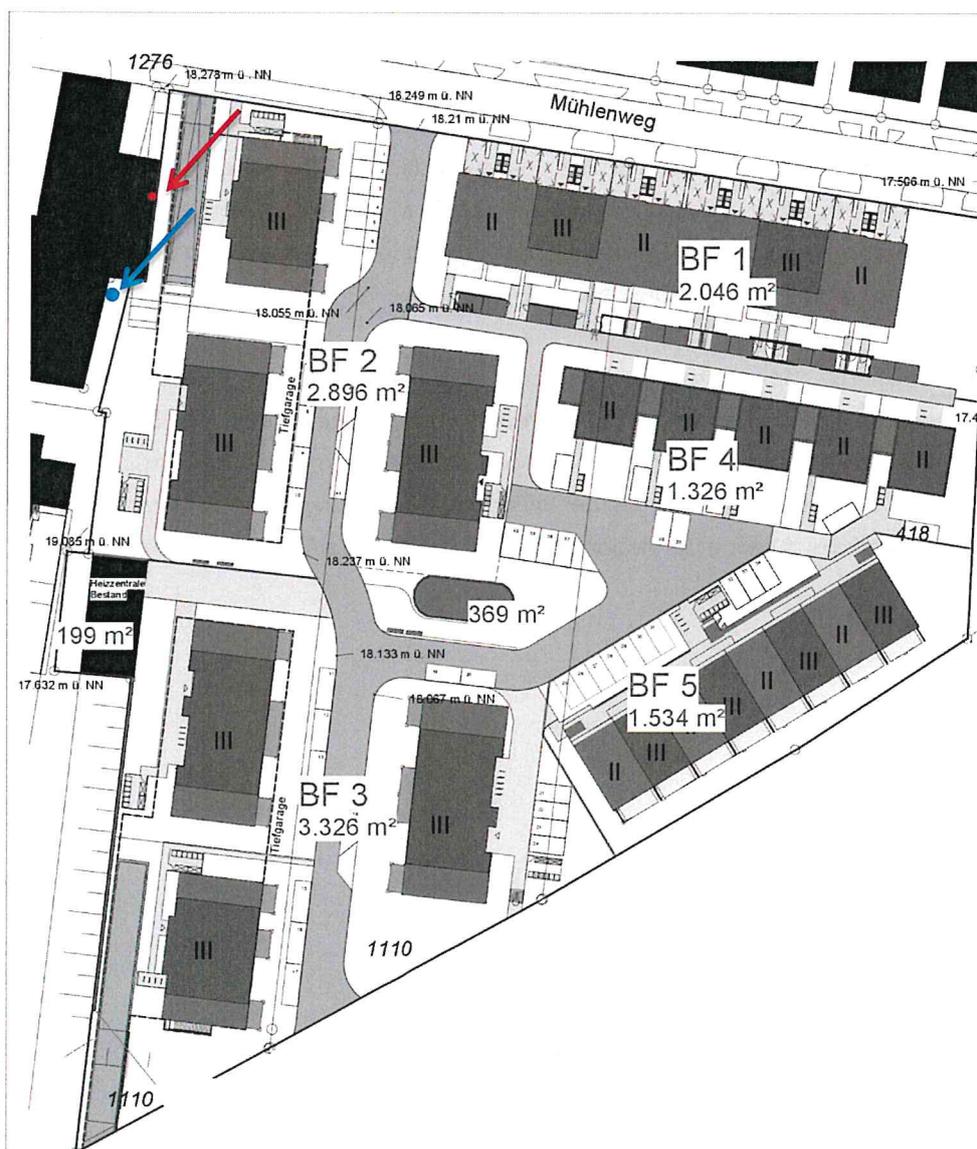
Lageplan Baugebiet, Lage Kamin Lackieranlage (rot), Lage Auslass Staubabsaugung (blau)
